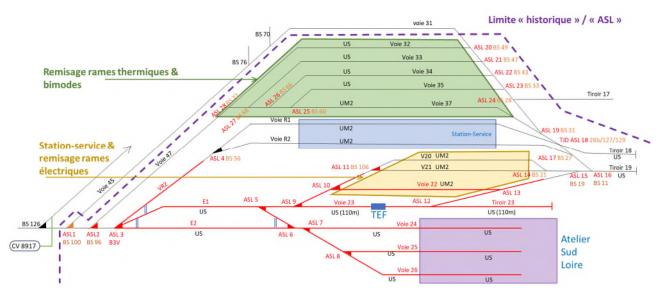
SCHEMA DES INSTALLATIONS FERROVIAIRES PROJETEES DU PERIMETRE TCSL (OU ASL) (SOURCE : DOSSIER PRO)
